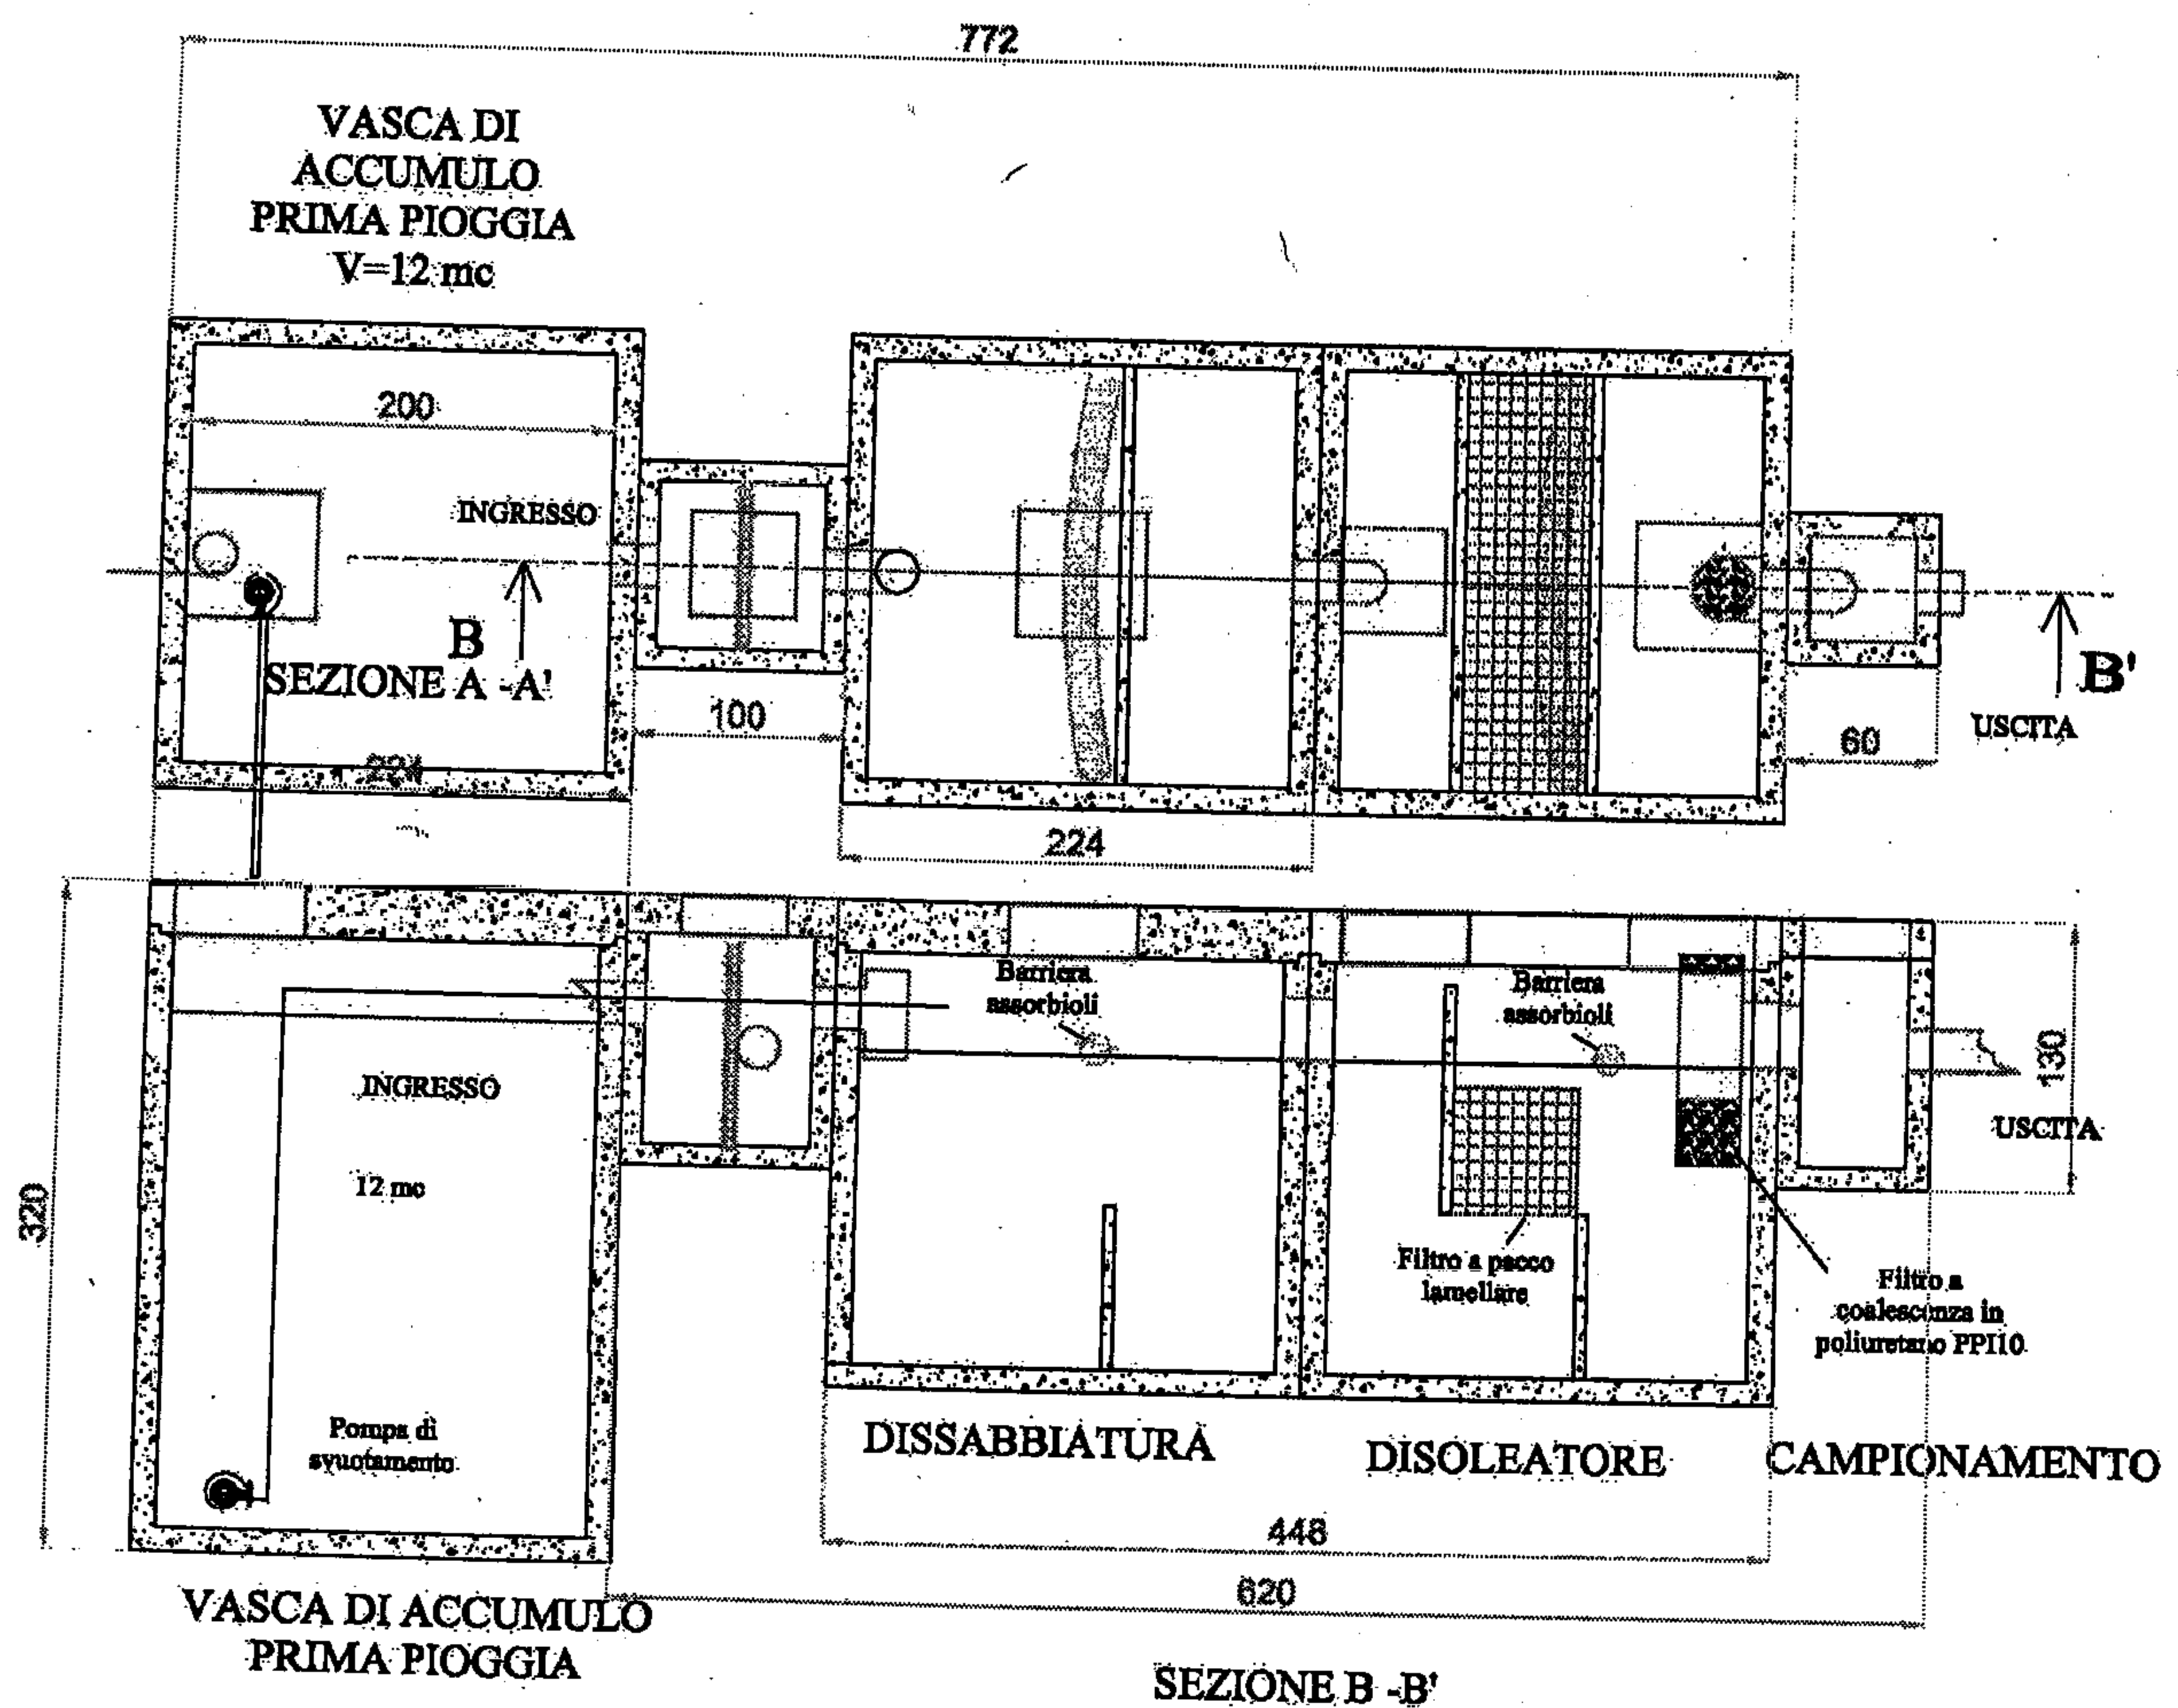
PIANTA E SEZIONE DELL'IMPIANTO
